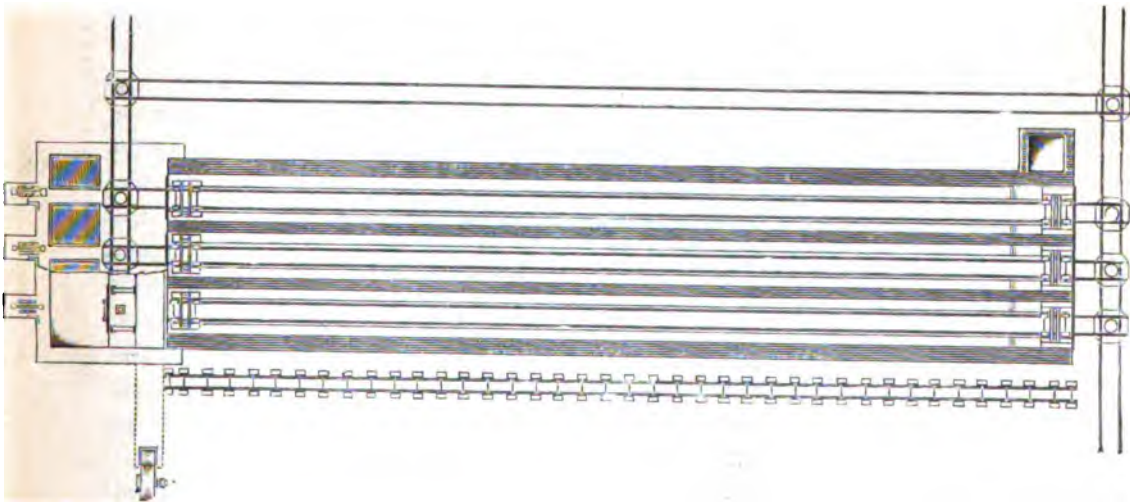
Grundriß der oben gezeichneten Kanaltrockenanlage.
